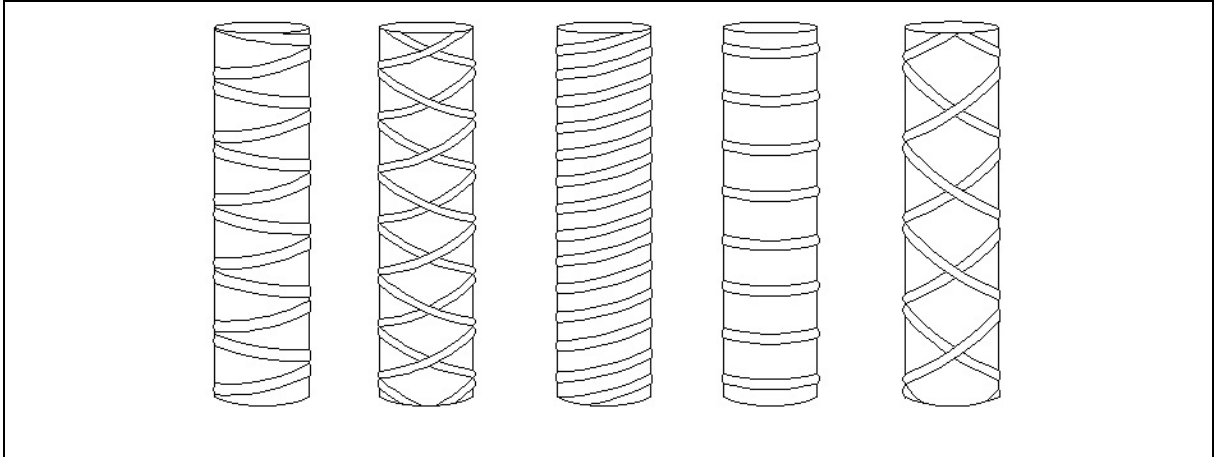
Tipos de barras de refuerzo corrugados.
